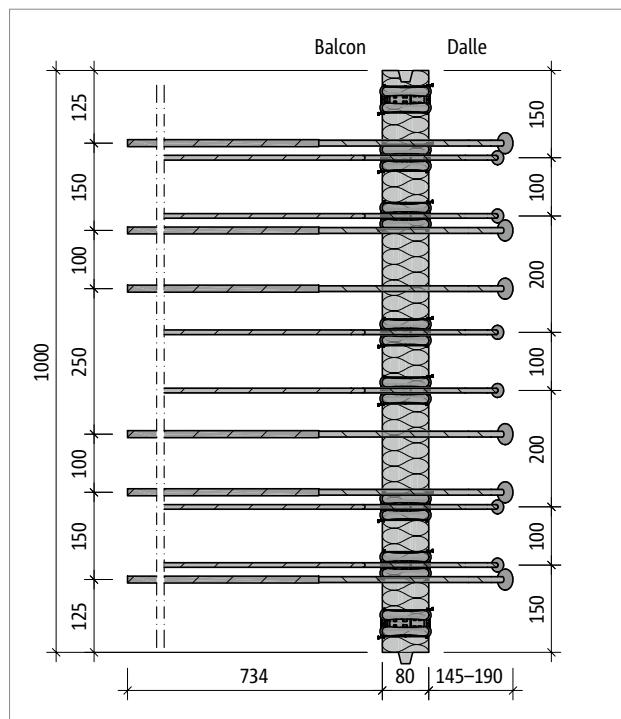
Schöck Isokorb® T type K-O-M2 : plan de base du produit
